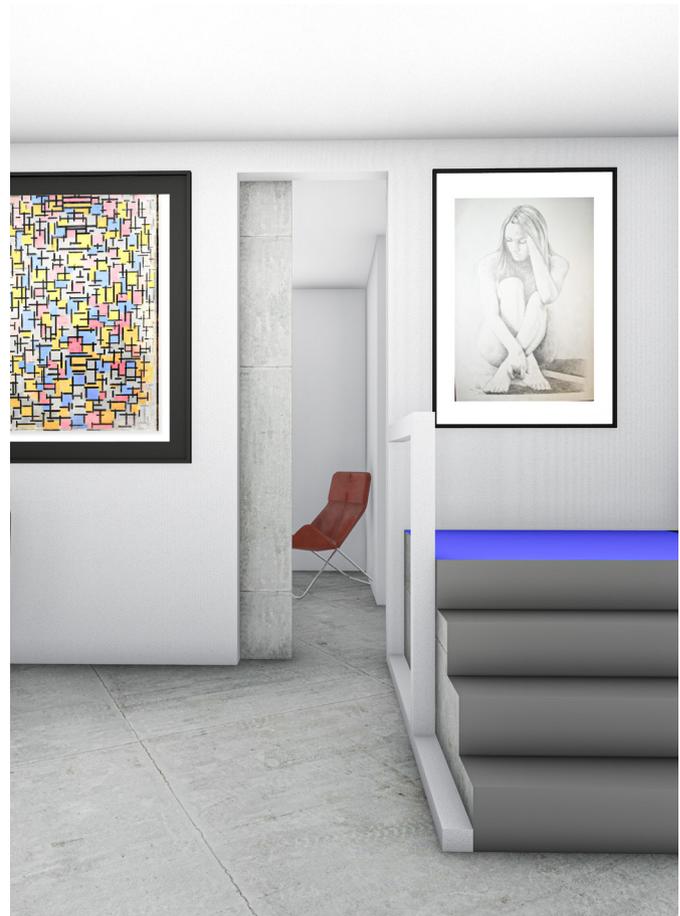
Planta baja - Estancias más o menos de la misma dimensión.
